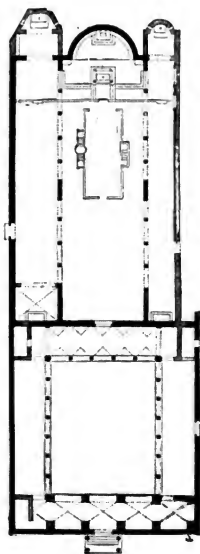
S. Clemente in Rom. Grundriss.
